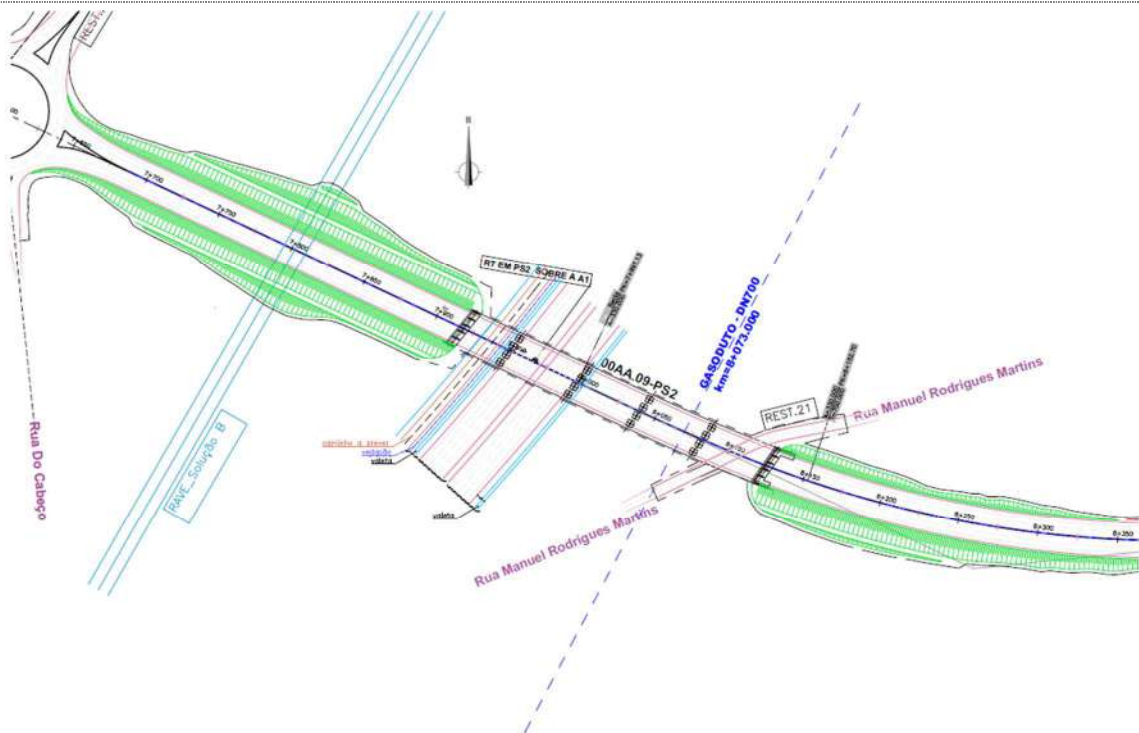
Localização da RAVE (Solução B) e do projeto em estudo – Planta
